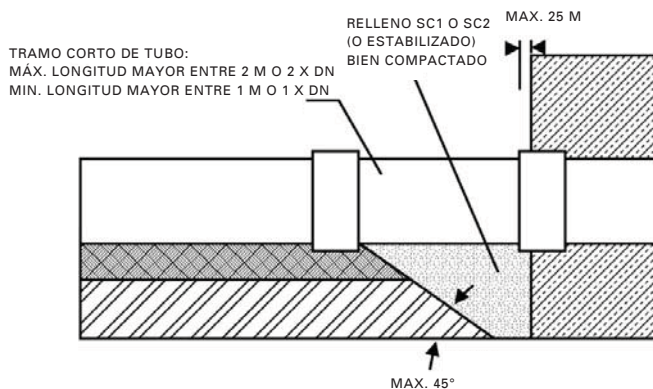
Conexión Estándar. Acople empotrado en concreto
